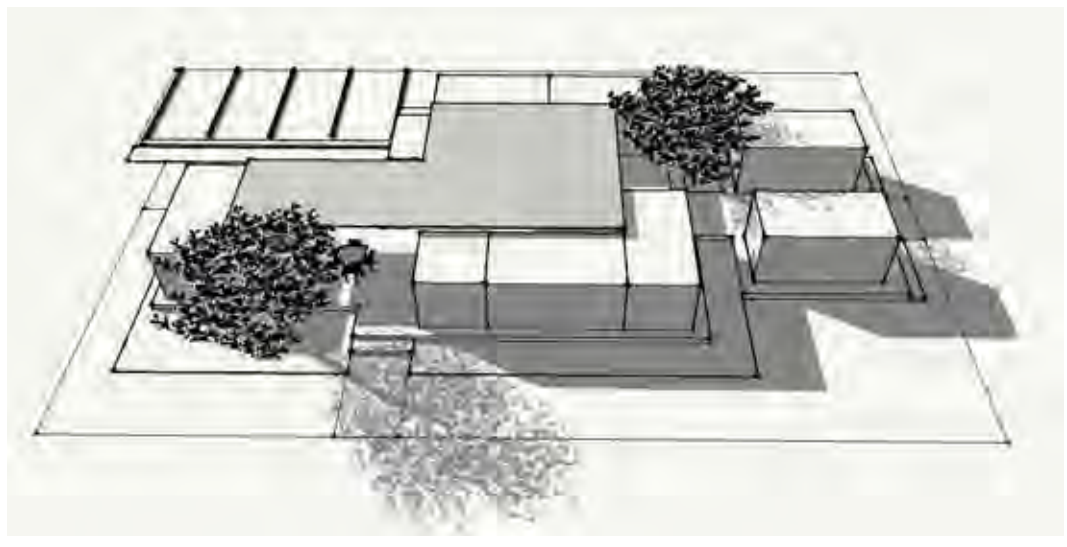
Campamento en obra Fuente: Elaboración propia 2010
